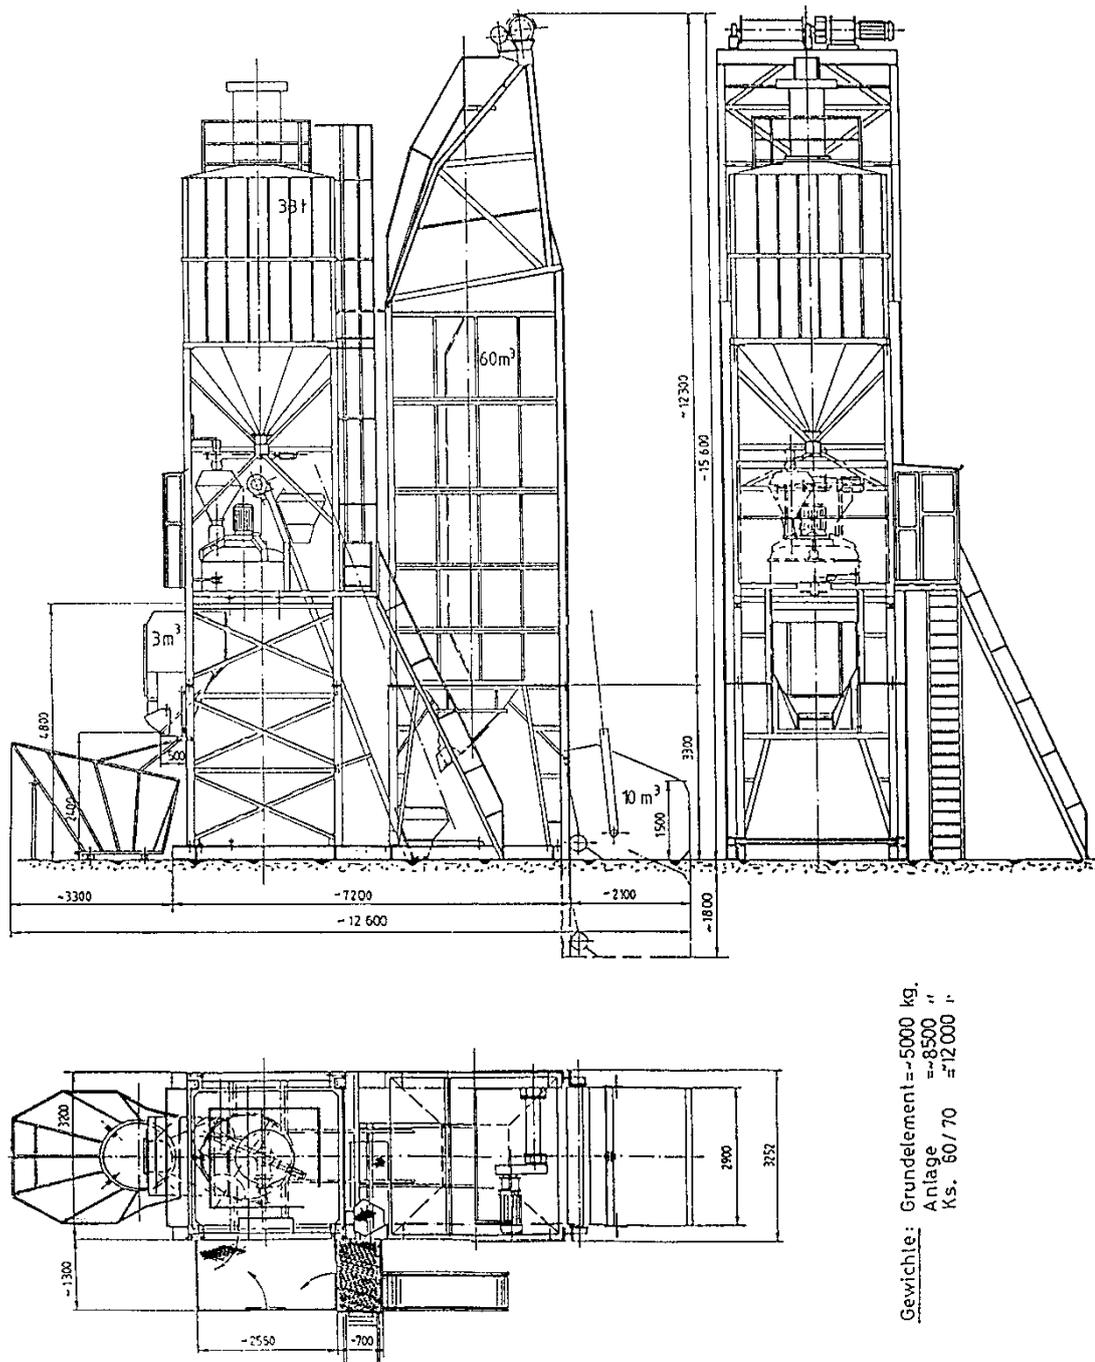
Baustellen-Vertikalsilo-Betonmischanlage [7]
